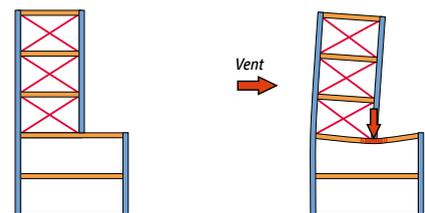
Poteau d'un contreventement par triangulation interrompu sur une poutre – À éviter
